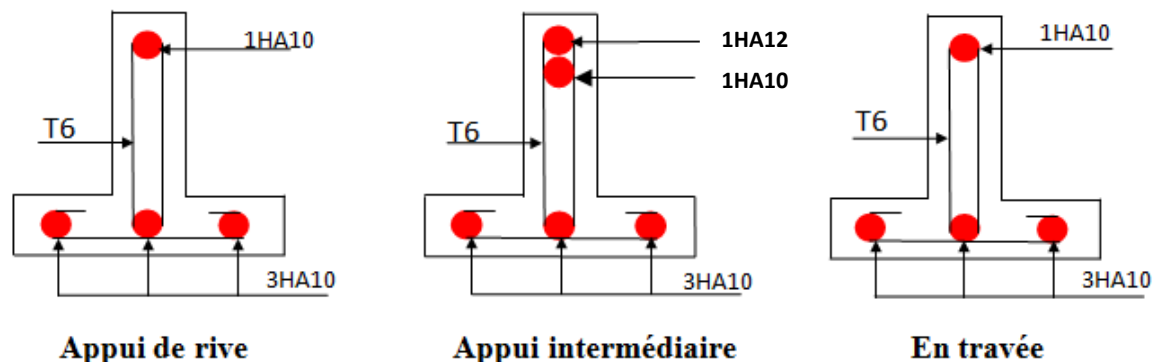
Ferrailage des poutrelles du plancher terrasse inaccessible
